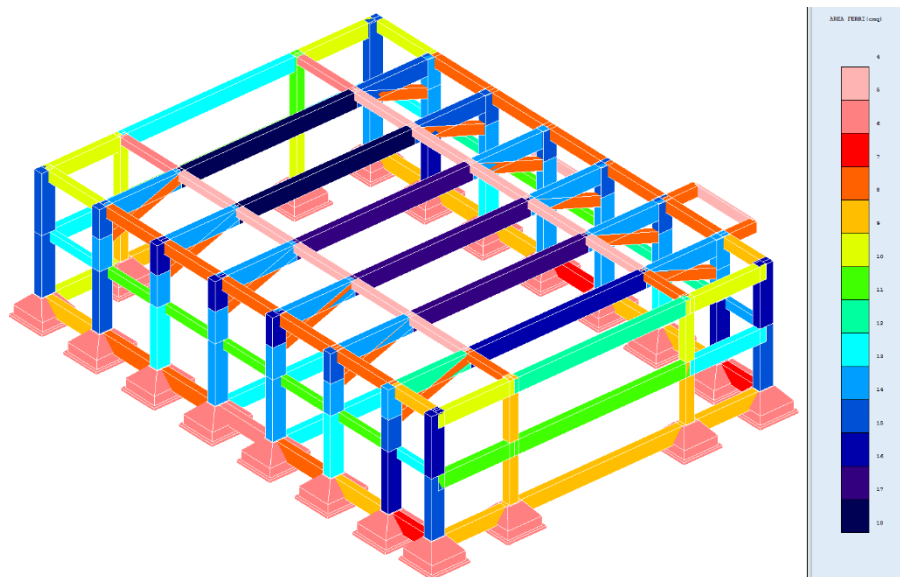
Sipërfaqja e armaturës gjatësore për elementët strukturorë
